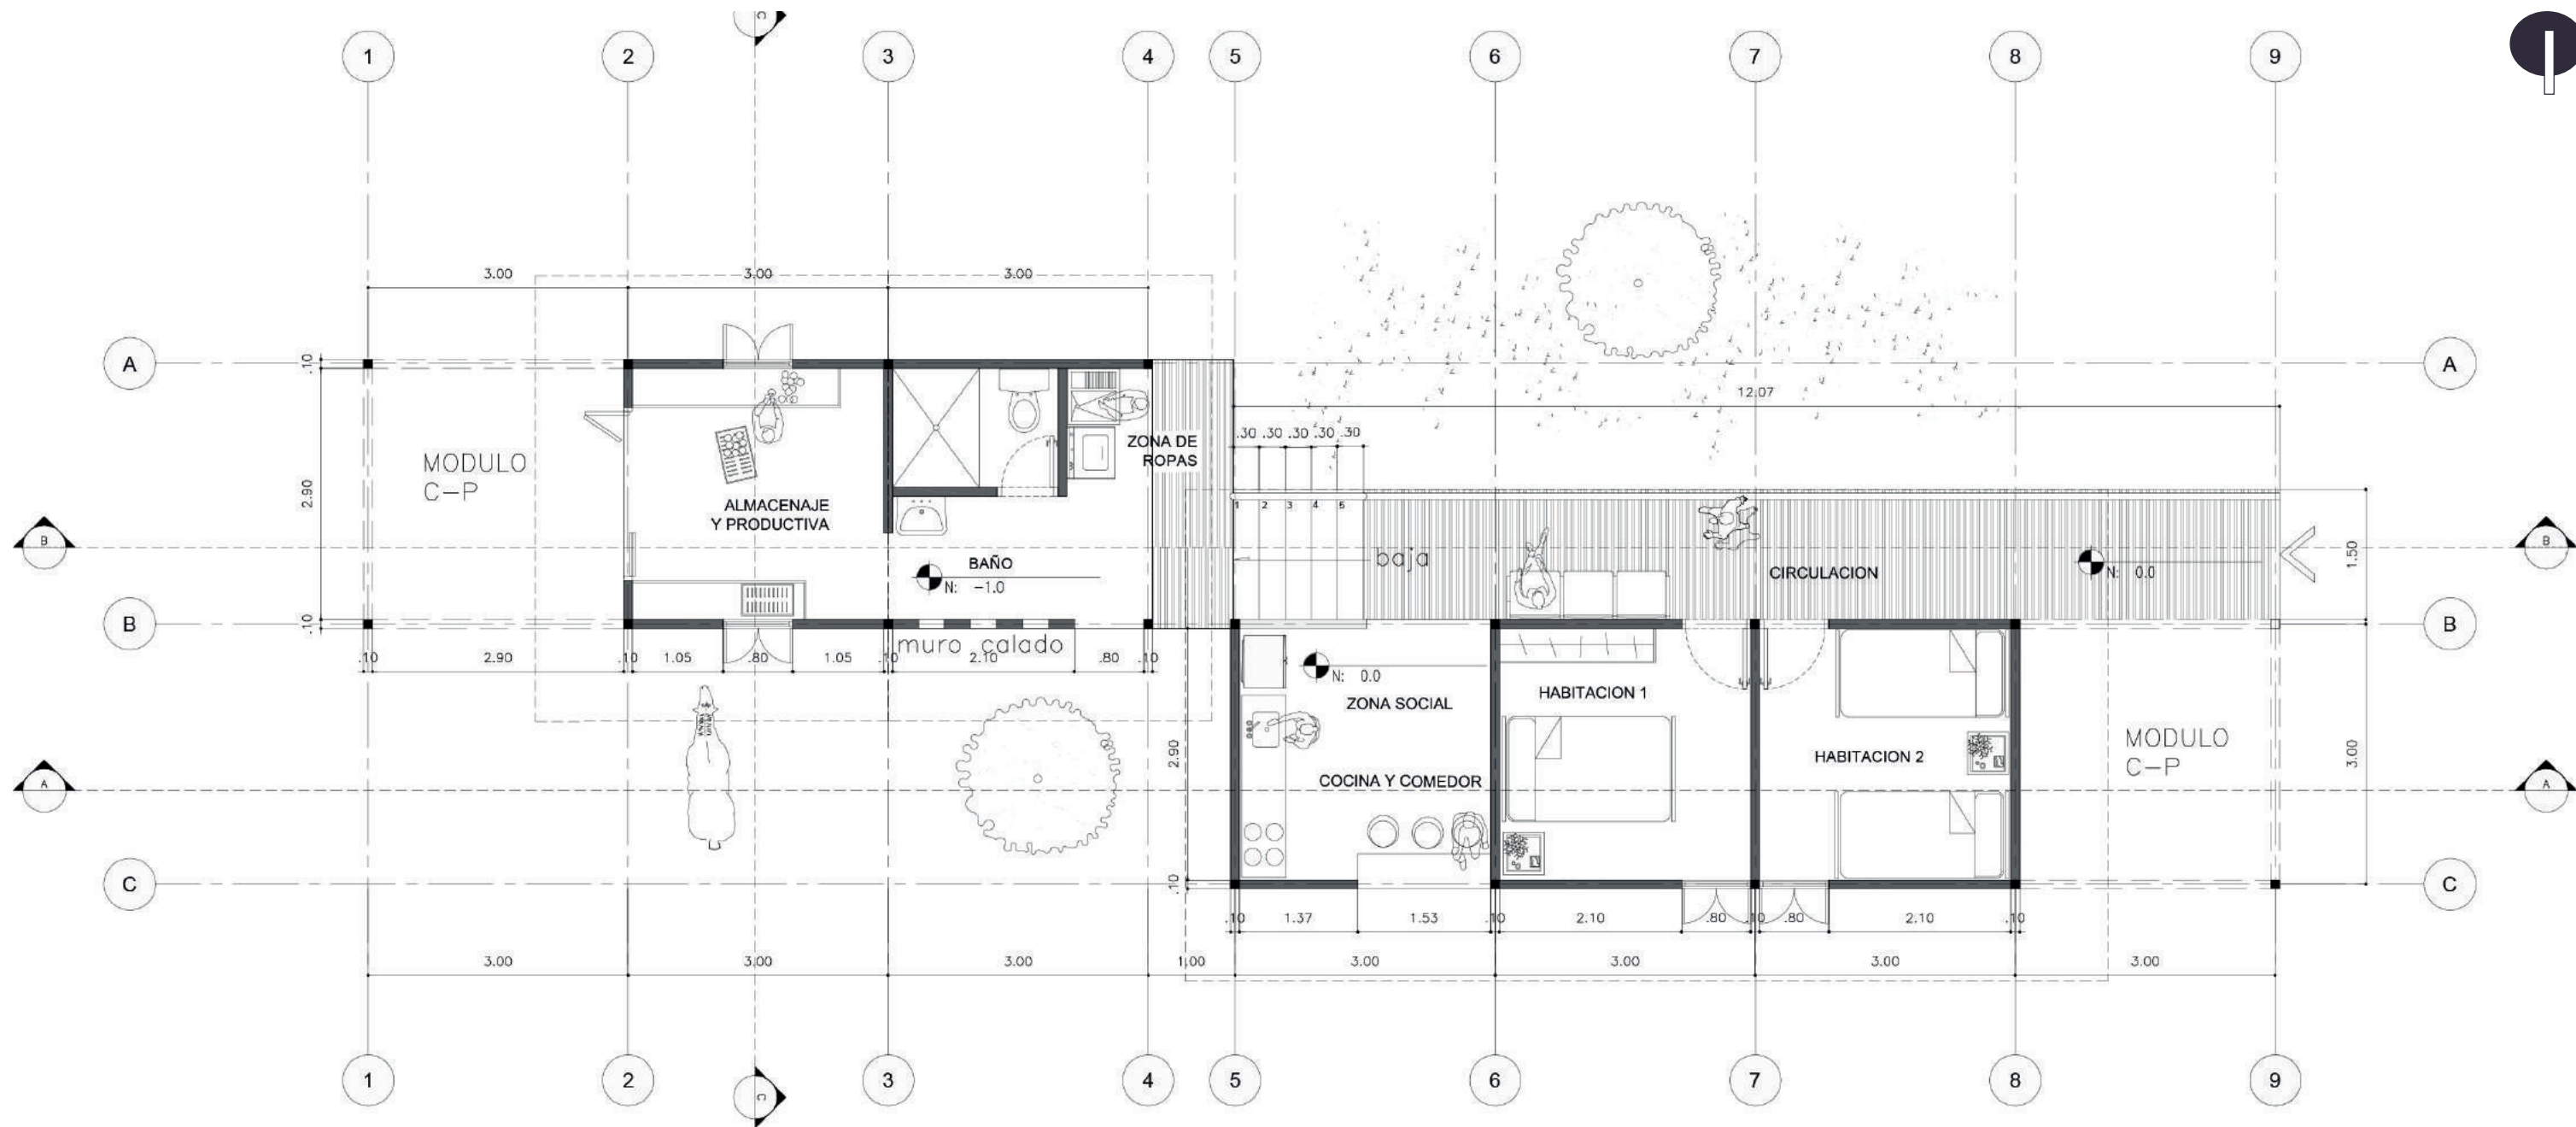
, Planta arquitectónica media montaña, Julián López, Juan Diego López, 2020.
